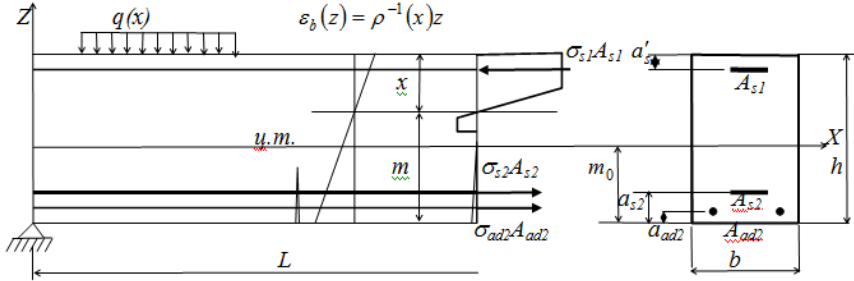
Схема железобетонного элемента после усиления дополнительной арматурой A_{ad2}
